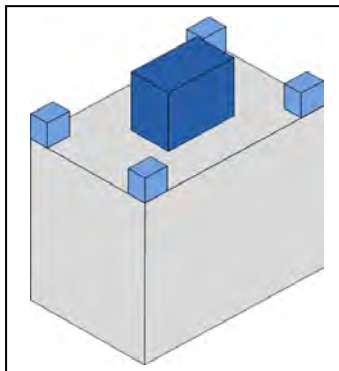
EDIFICAÇÃO COM COBERTURA RECONSTRUÍDA
